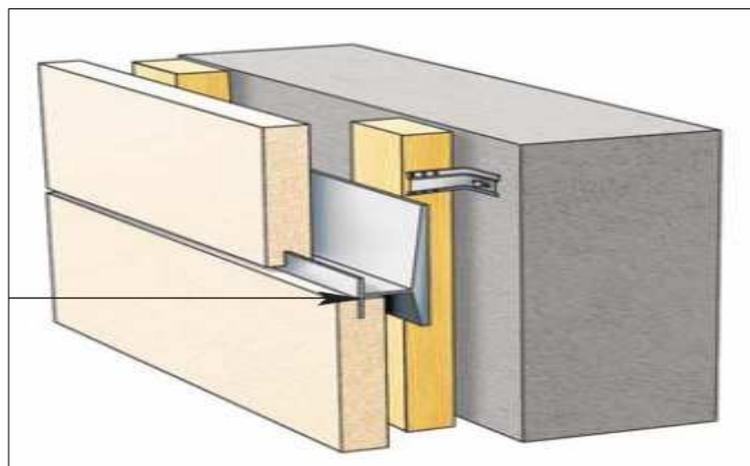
Colocación de placa de revestimiento sobre estructura de perfiles de fijación secundaria.
